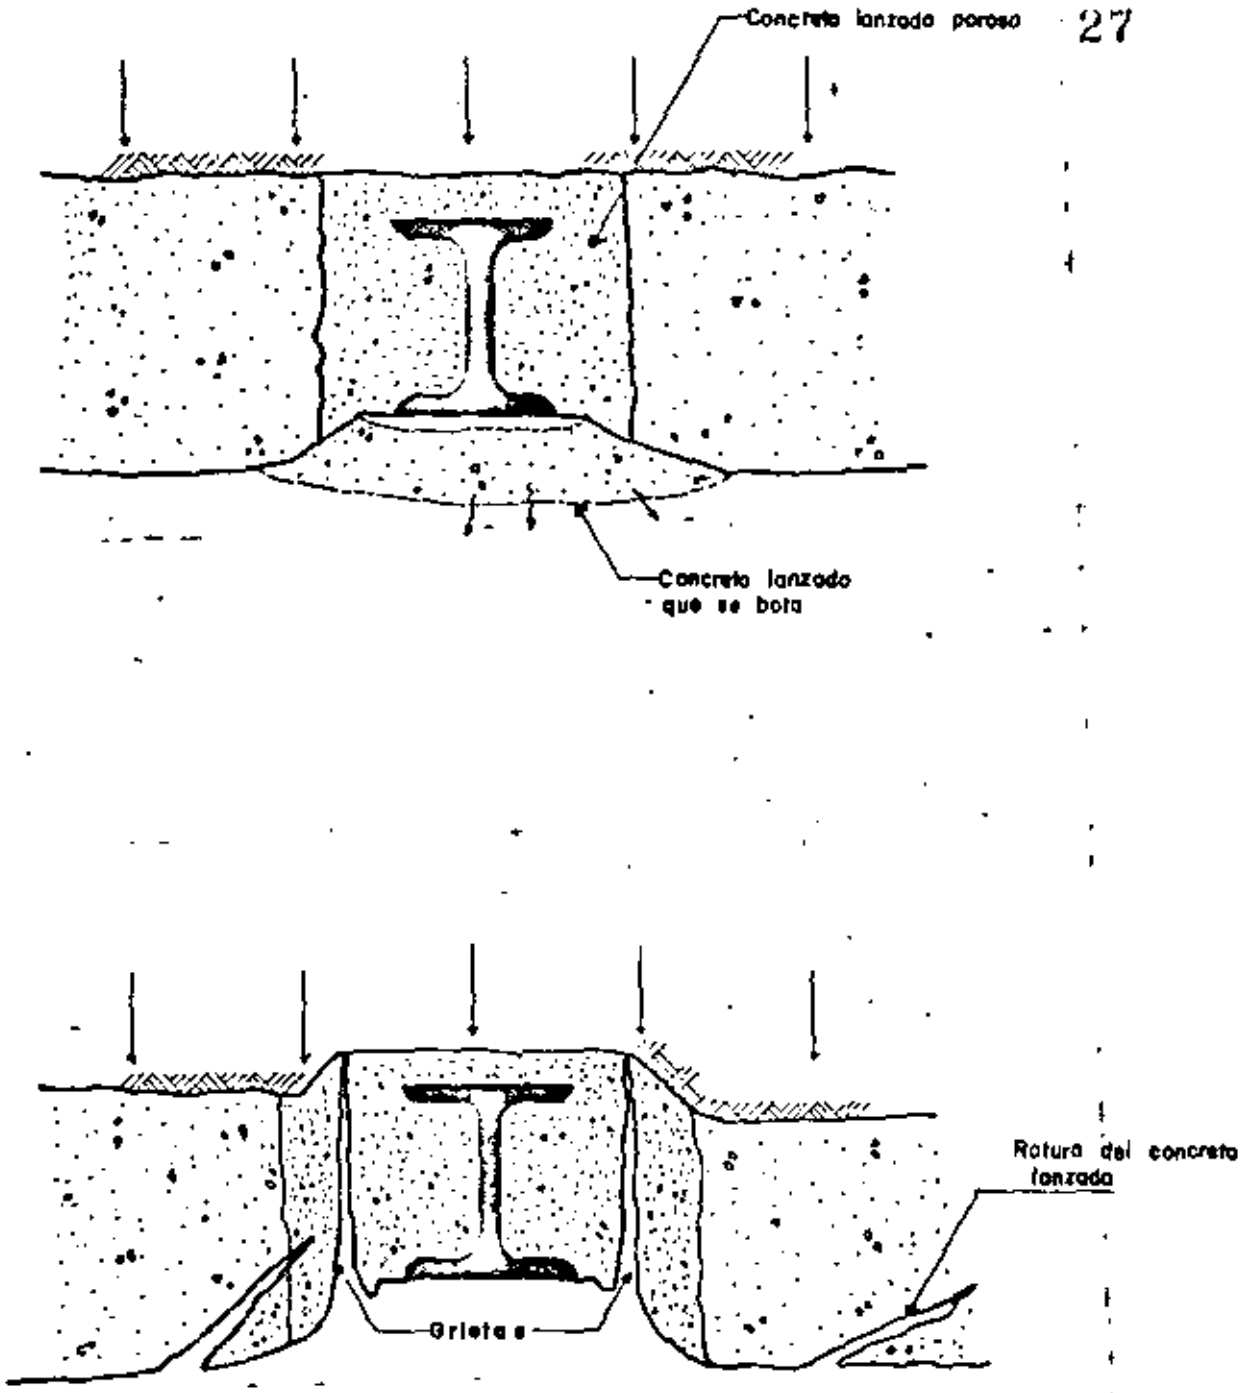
ROTURA DEL SISTEMA CONCRETO LANZADO-VIGUETAS DE ACERO
